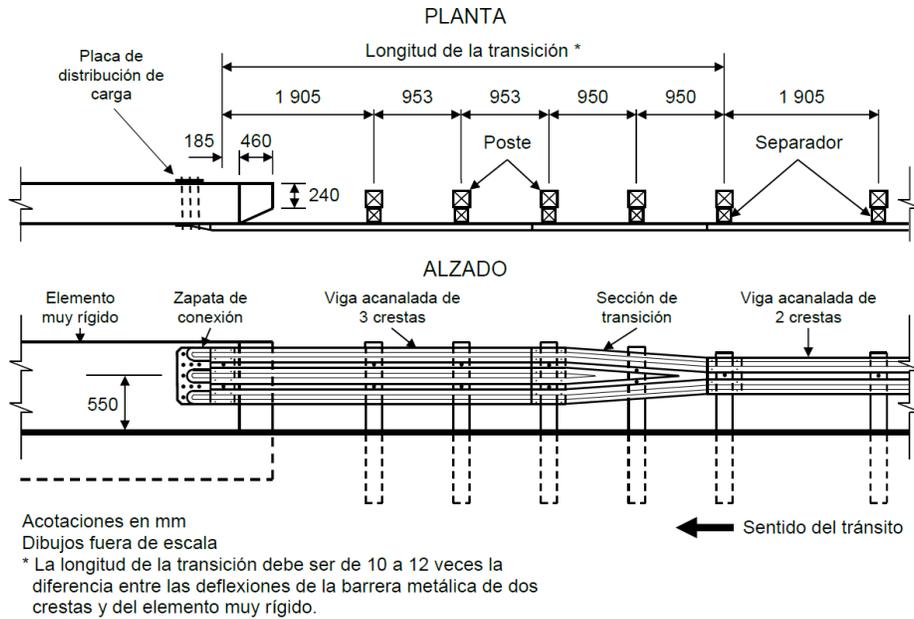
Transición de barrera metálica de dos a tres crestas y muro vertical recto
